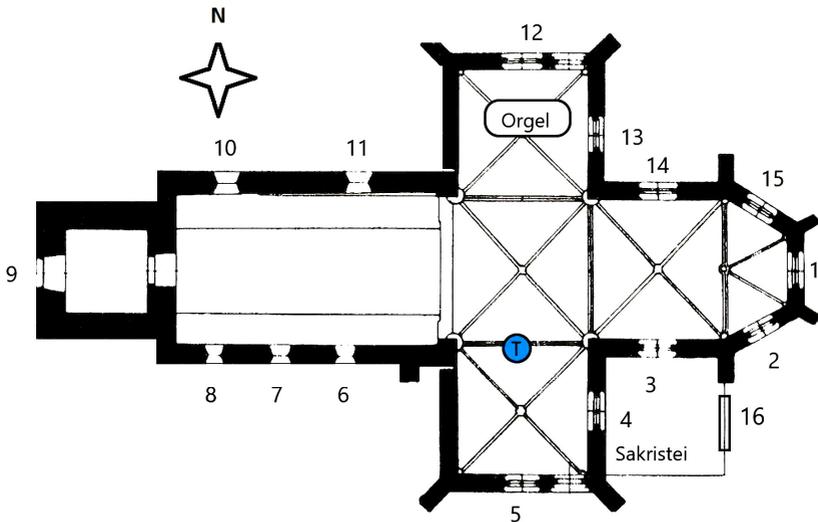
Grundriss Pankratius-Kirche
